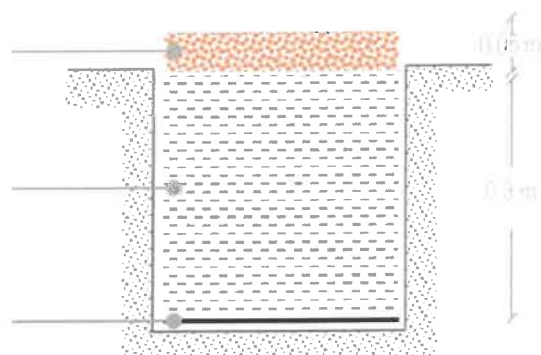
| Coupe structurelle sable stabilisé de Marquise
